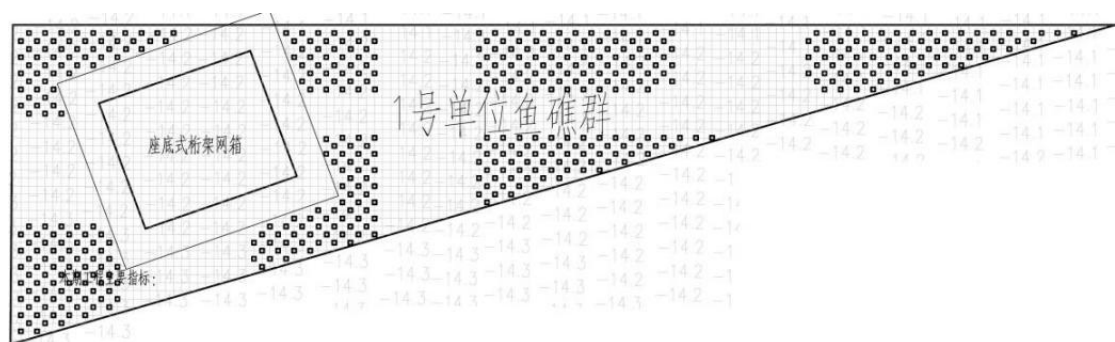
人工鱼礁区 1 号鱼礁群布置图
